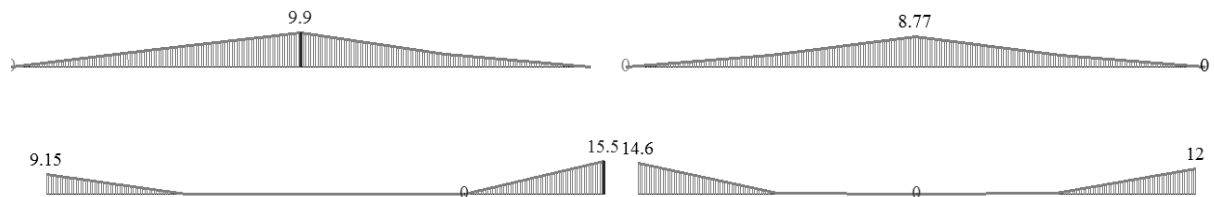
Эпюры требуемого армирования, а – нижнее армирование, б – верхнее армирование
